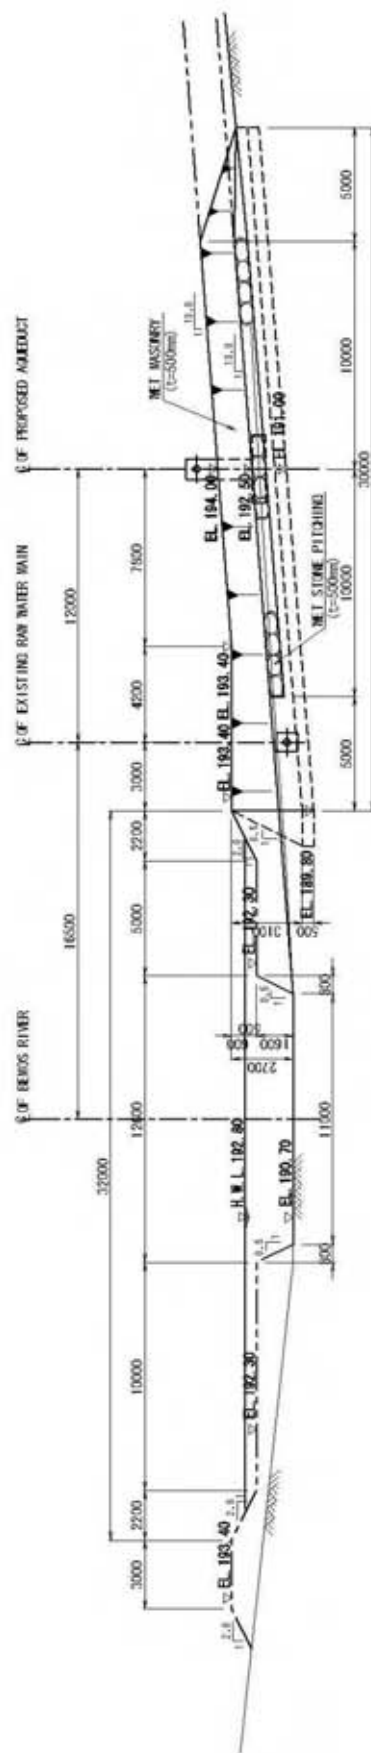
改修箇所No.4:第1河川横断工 縦断面および断面図
